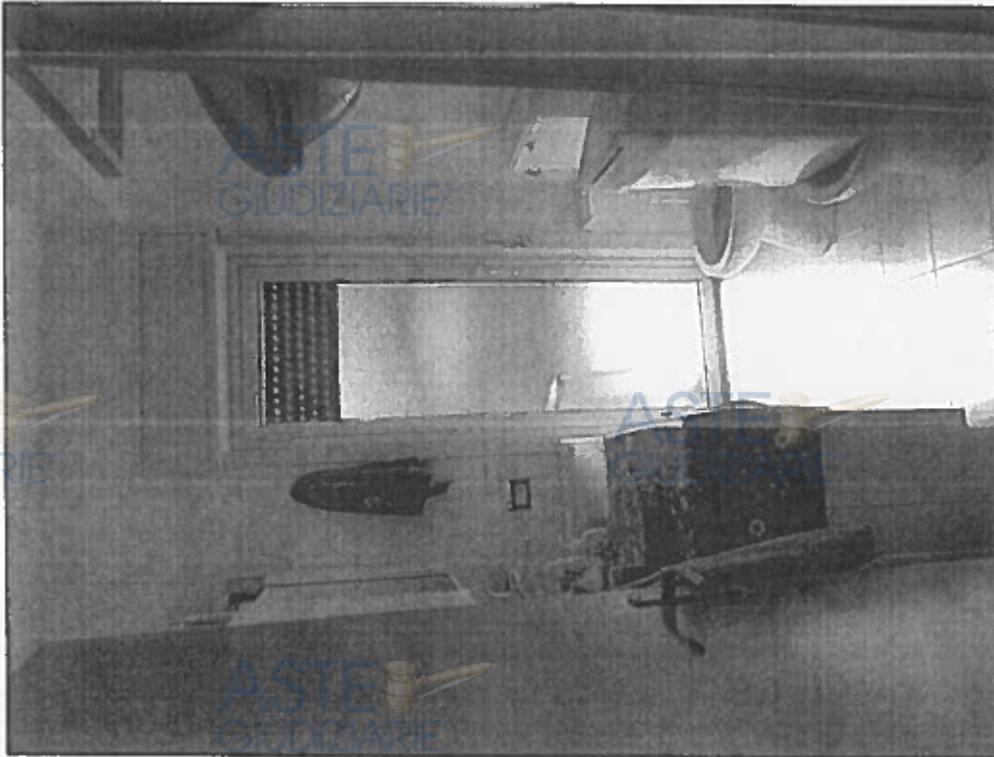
APPARTAMENTO SUB 6 - LAVANDERIA
